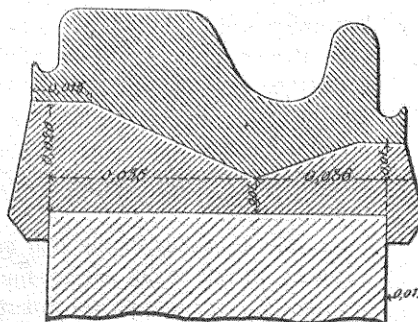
Coupe d'une plaque de joint. Échelle 1/2.
